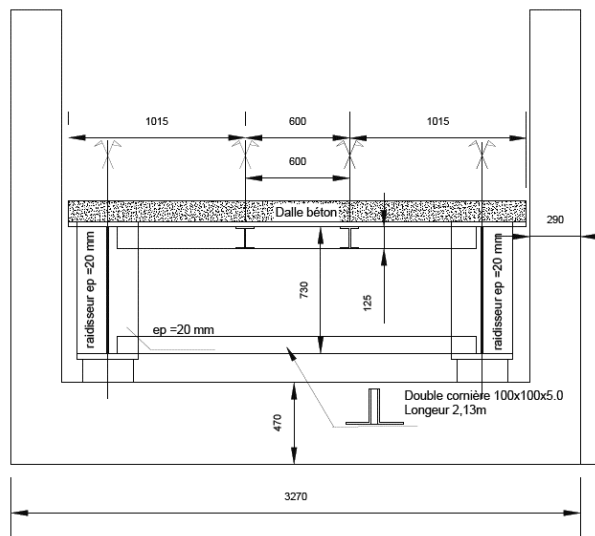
Coupe transversale de l'ouvrage - section sur culée
